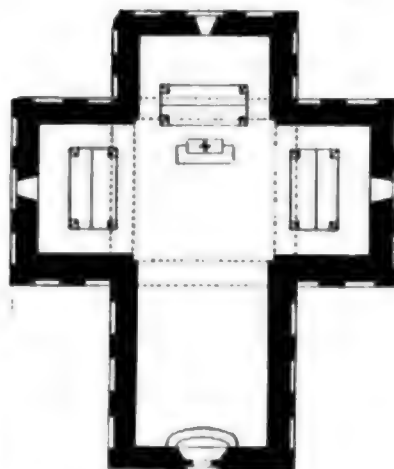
Planta del mausoleo de Gala Placidia. RÁVENA.
